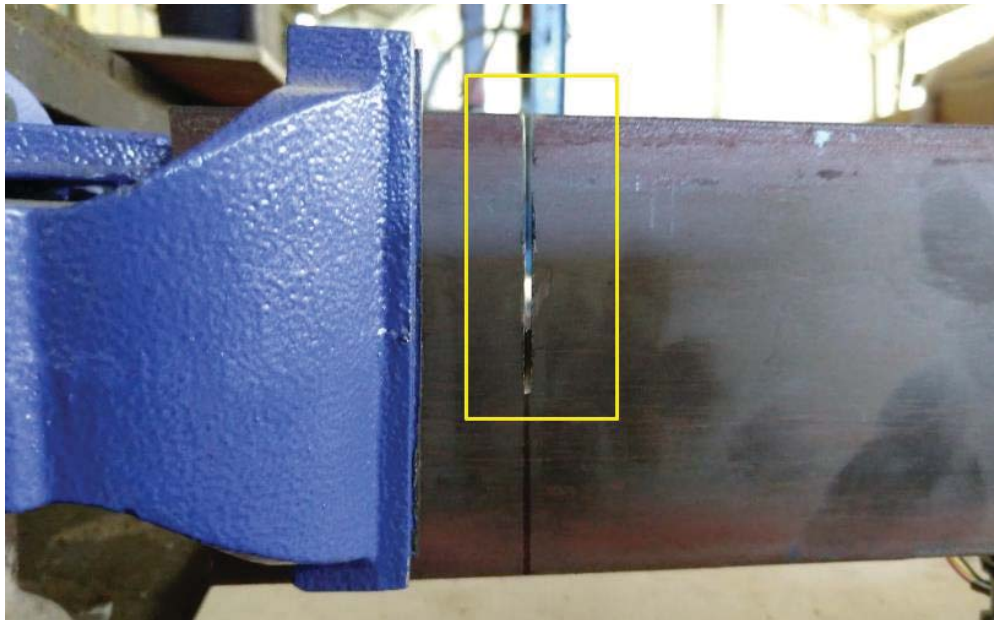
Viga con grieta extensa, 46 [mm] de profundidad.
